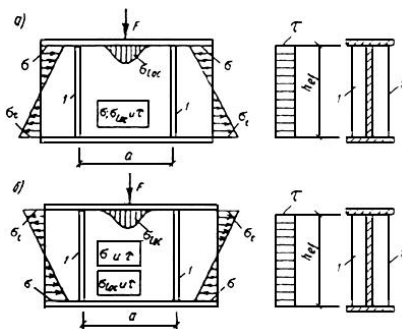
Схема балки, укрепленной поперечными основными ребрами жесткости (1)
